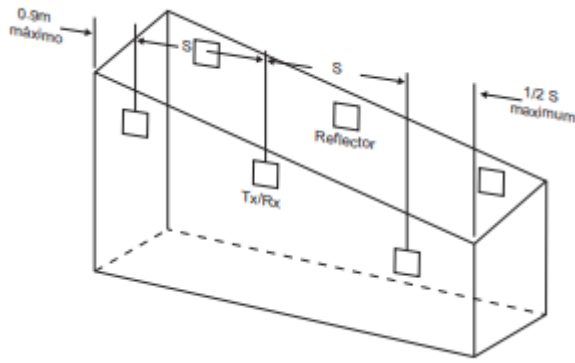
Guía de instalación de detectores beam para techo inclinado de tipo cobertizo. OSID (2019)
